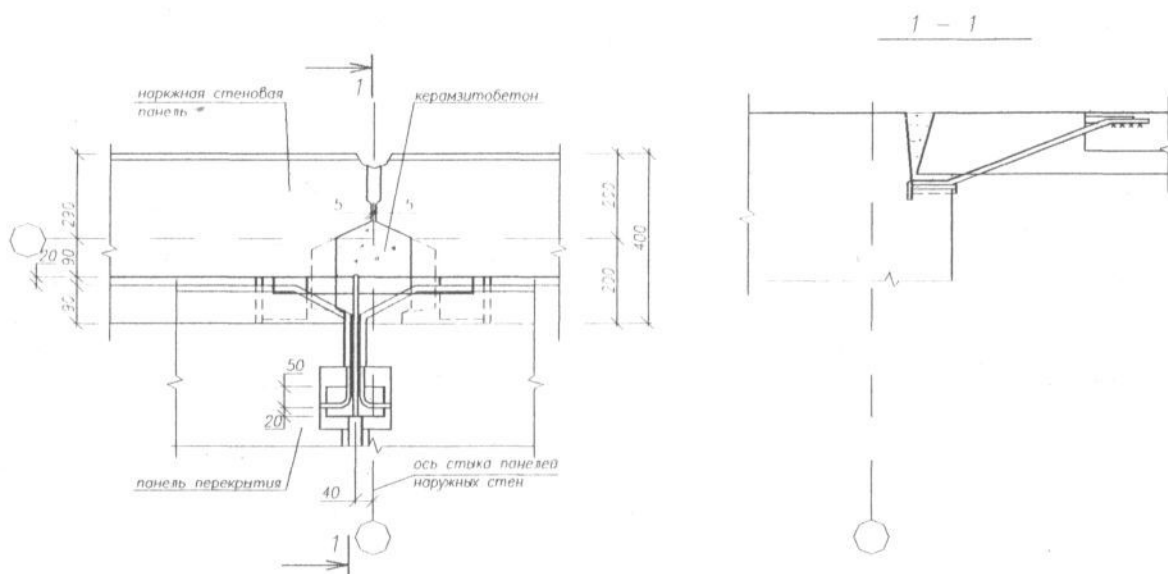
Стык наружных стеновых панелей с панелями перекрытий
